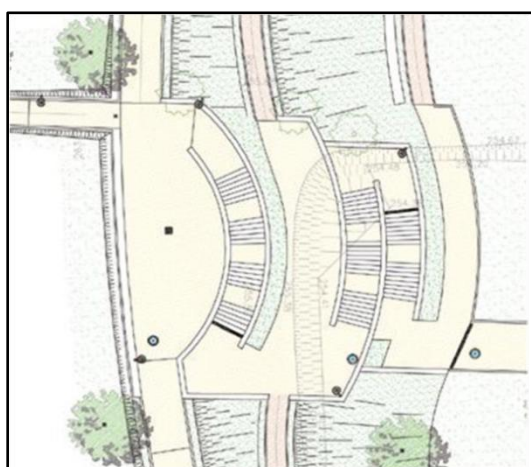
PLAN MASSE DE L'ESCALIER PERMETTANT LA TRAVERSEE DU TALUS PAR LES PIETONS
